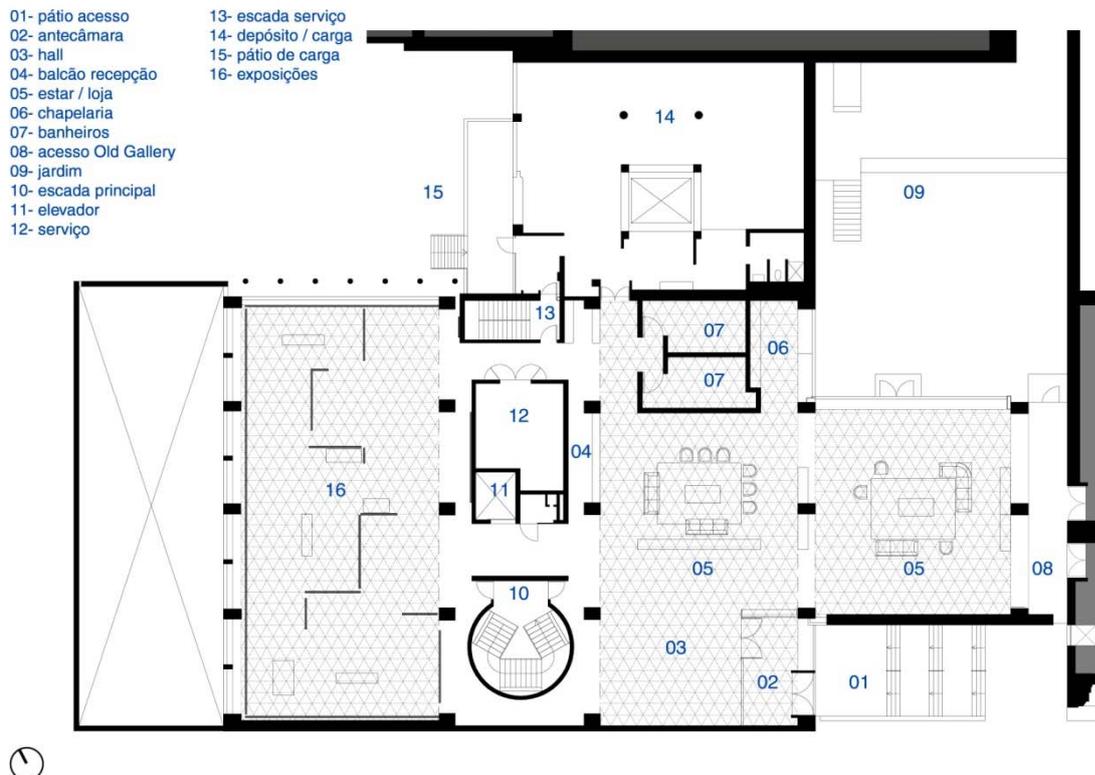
| Planta térreo YUAG [redesenho do autor]
